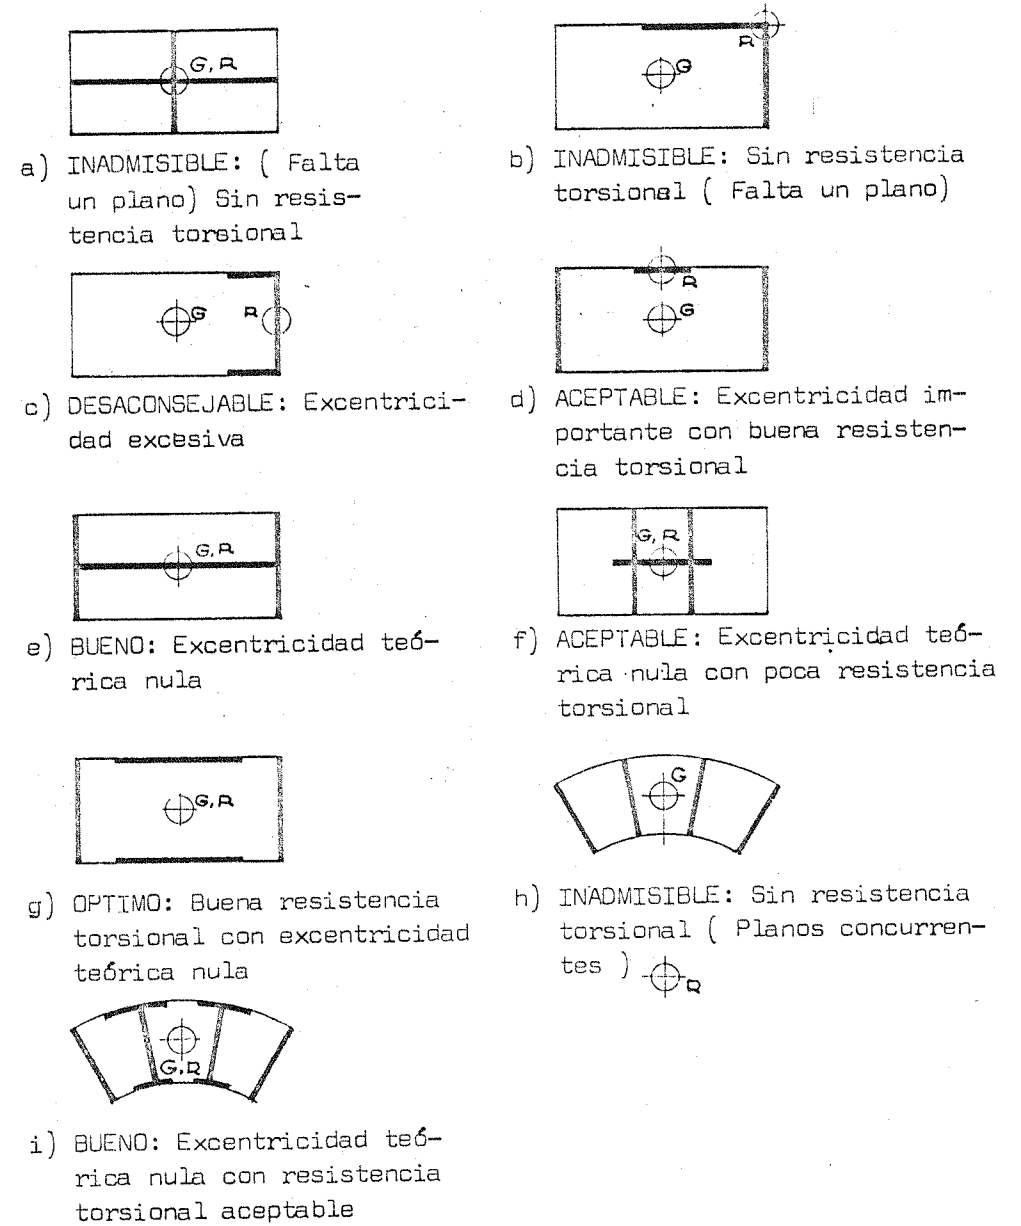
Influencia de la posición relativa de los planos verticales (G: Centro de masa ; R: Centro de rigidez)
